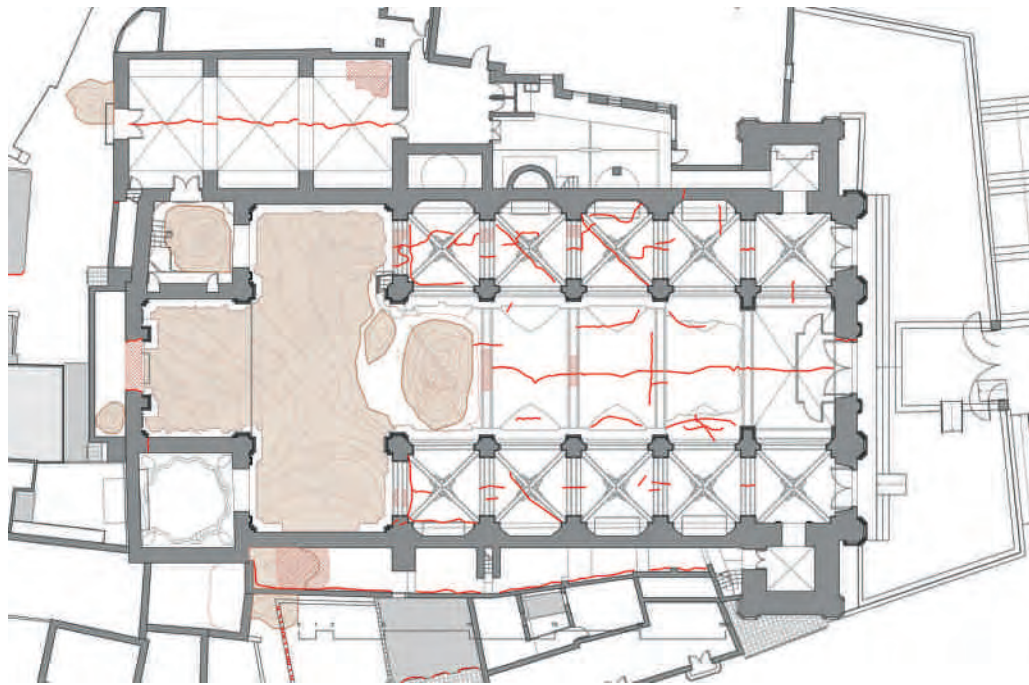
Planta de la iglesia, indicando la proyección de bóvedas y la zona del crucero donde se produjo el derrumbe, así como la nueva planimetría del mismo. Juan de Dios de la Hoz, Lavila Arquitectos.
